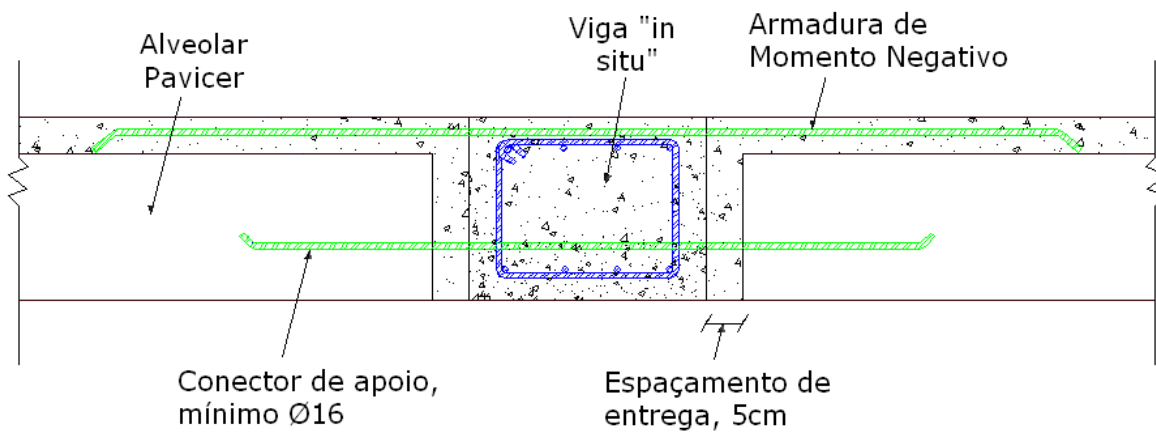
Pormenor tipo de apoio em viga central embutida.
